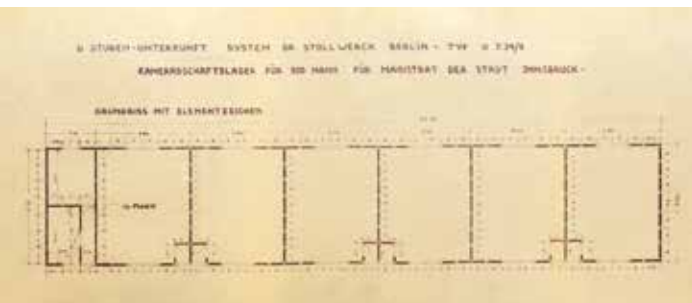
Grundriss einer Mannschaftsbaracke, Maßstab 1:100, September 1940.
